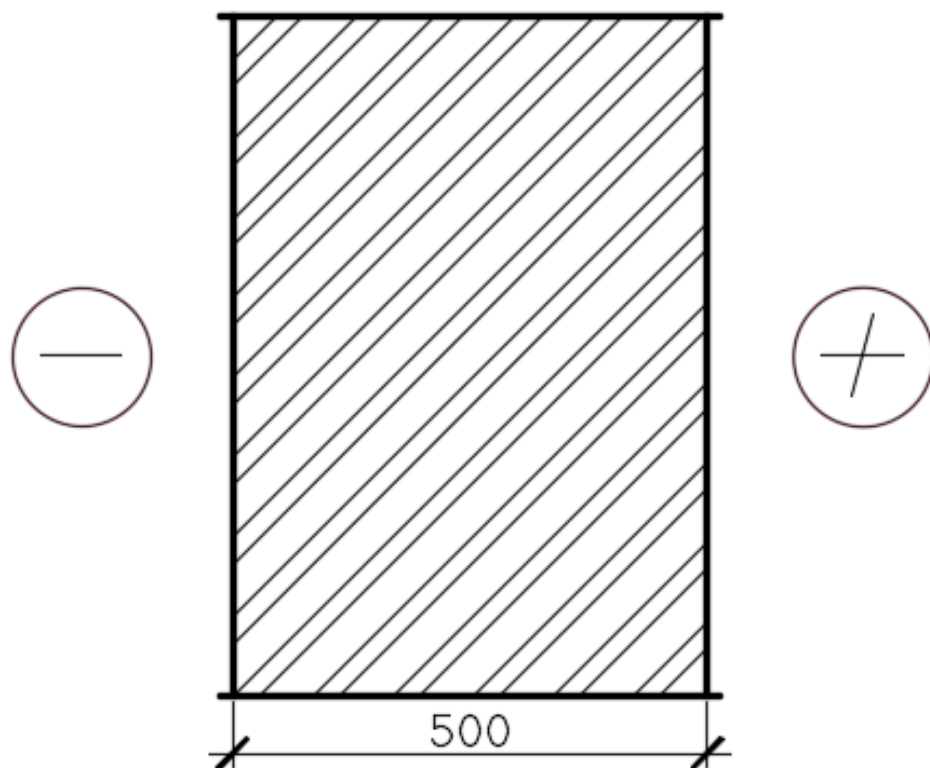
Схема ограждающей конструкции наружной стены
